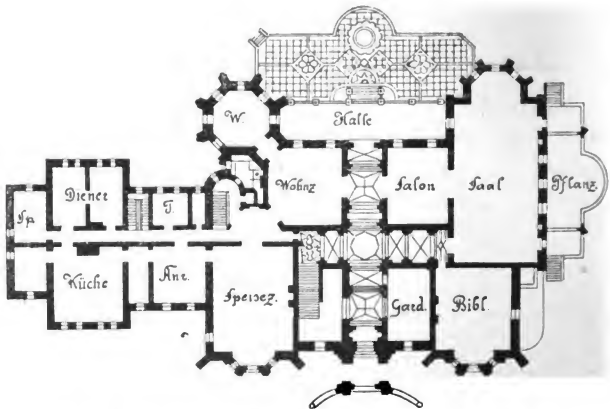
Grundriß des Schlosses Mühlenthal zu St. Magnus. Architekt Runge.
